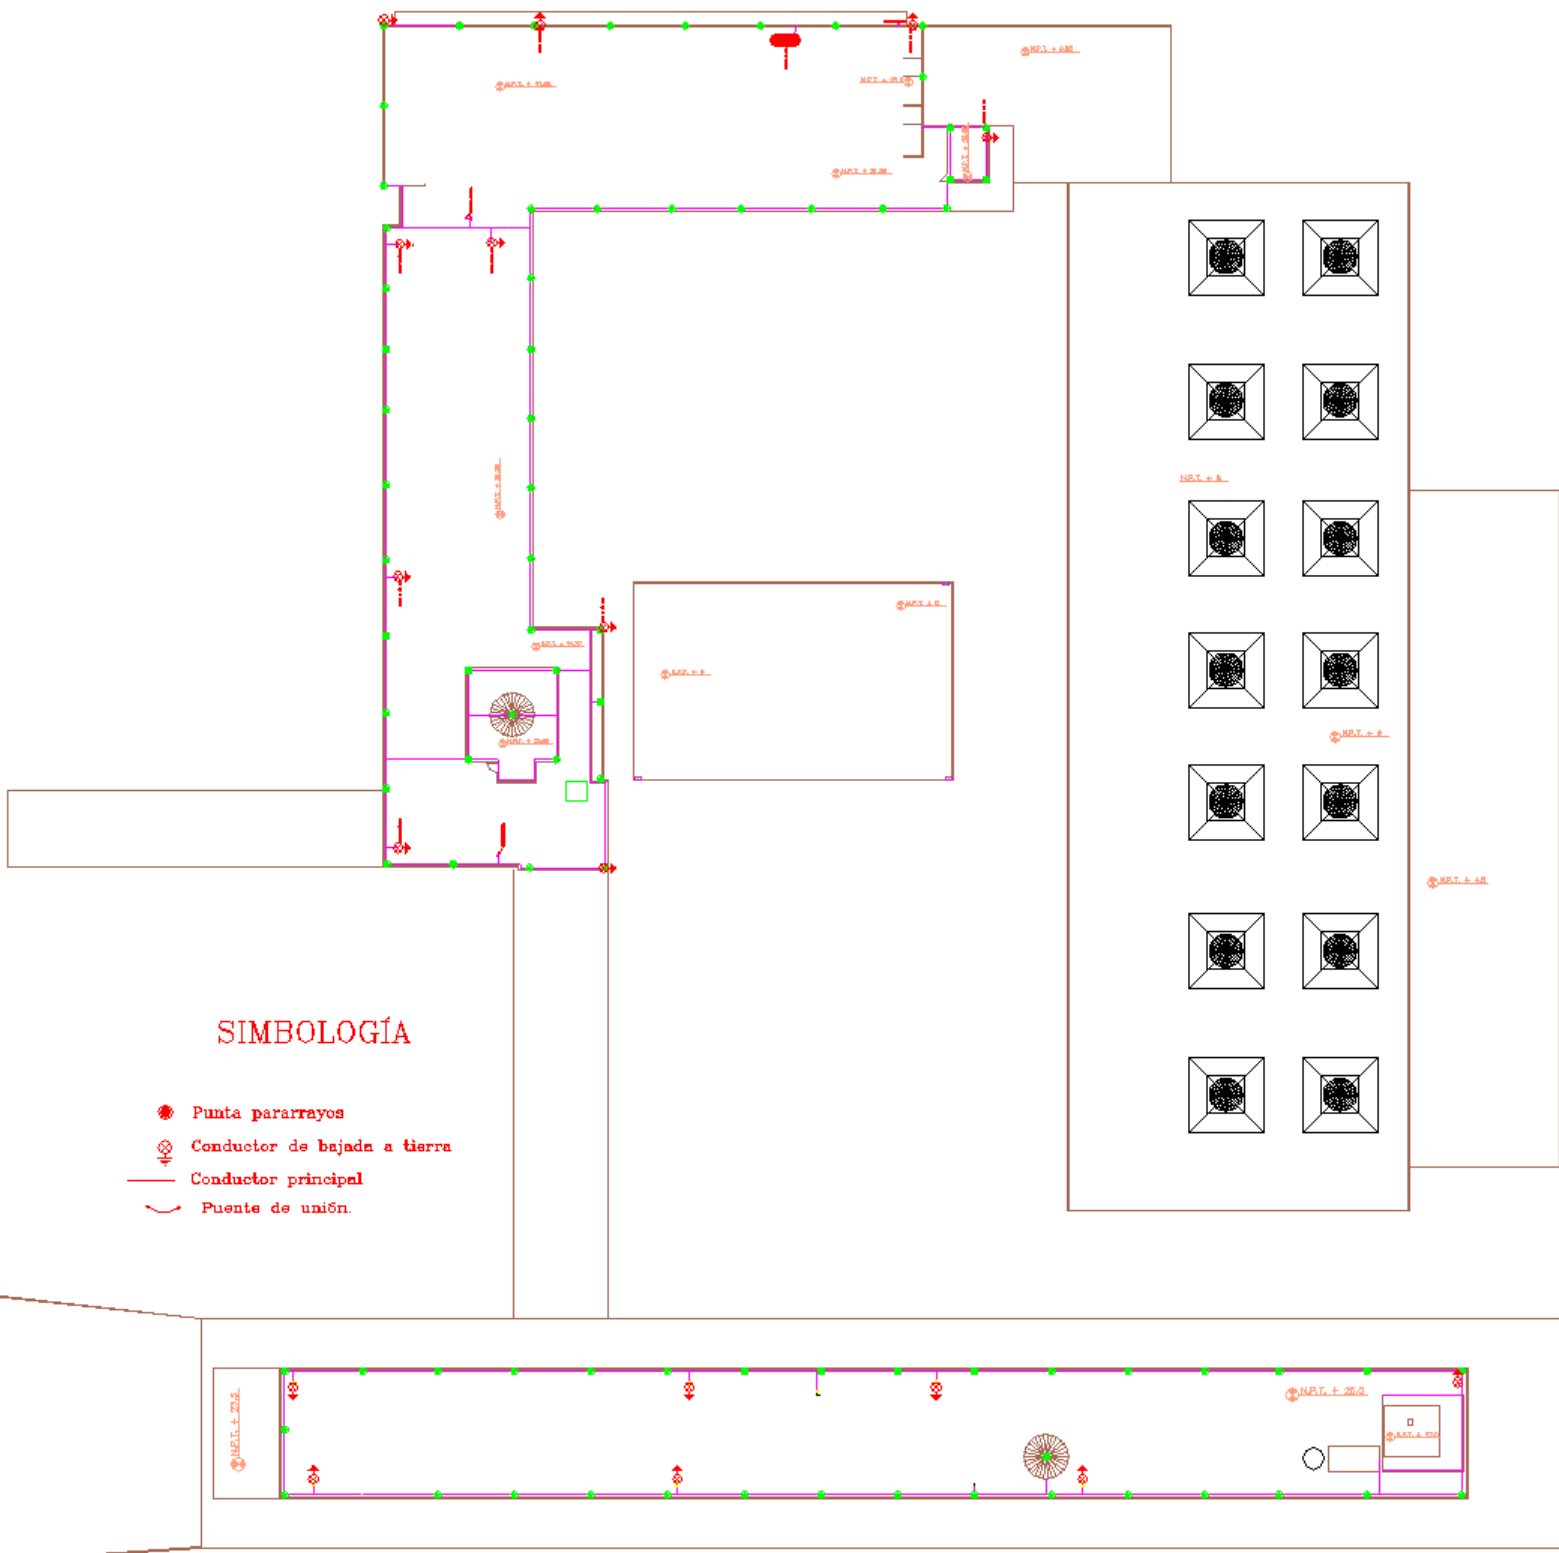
Plano del estado actual del sistema de protección contra descargas atmosféricas en la Facultad de Ingeniería de la Universidad Nacional Autónoma de México
